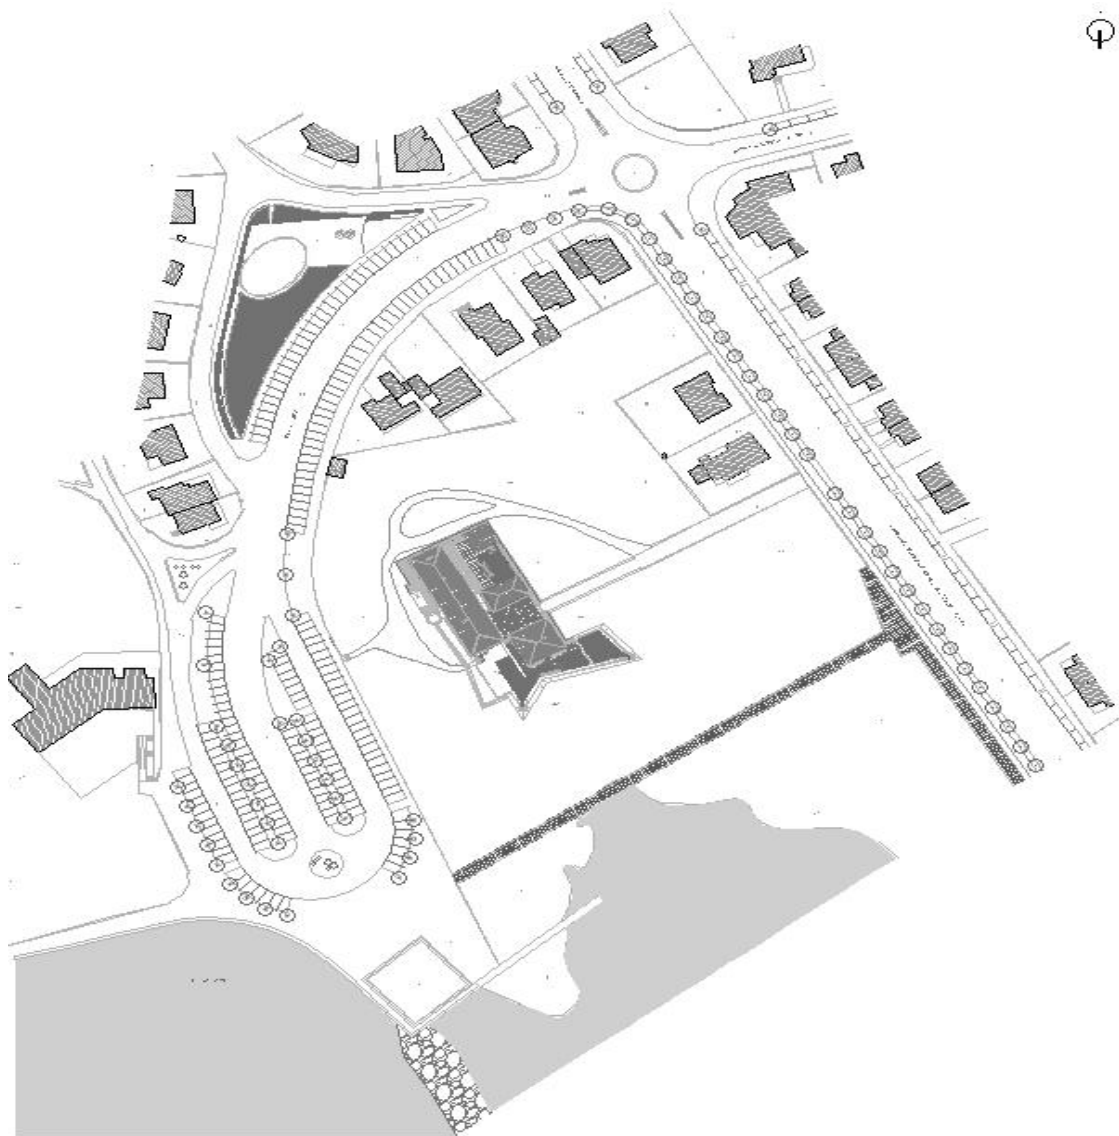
Levantamento Topográfico do Forte de S. João – Planta de Implantação.
